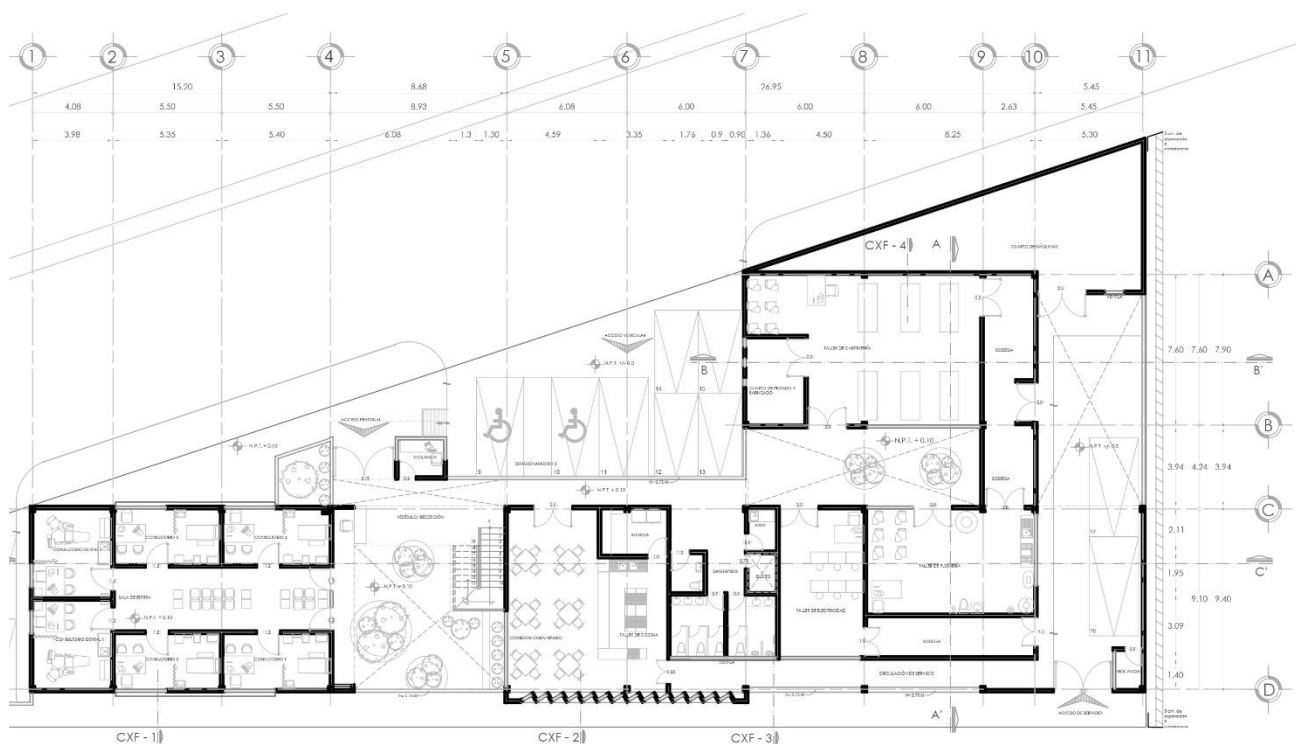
Plano de la planta baja, fuente: elaboración propia.
